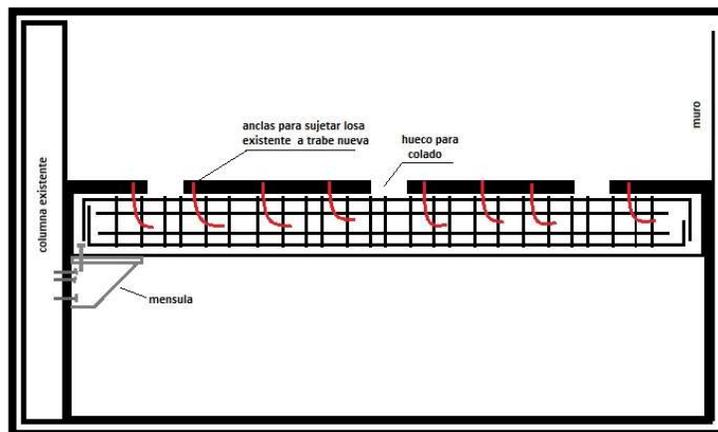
OpenAI. (2025). Corte en losa para acceso del colado de las vigas de refuerzo, imagen generada por IA.
